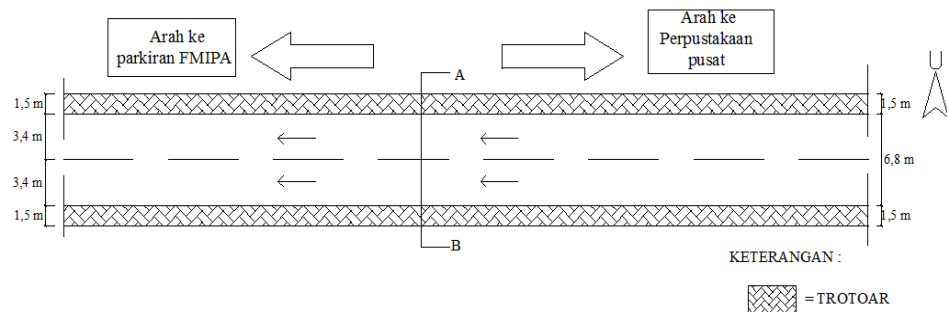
Potongan melintang ruas Jalan *Boulevard
